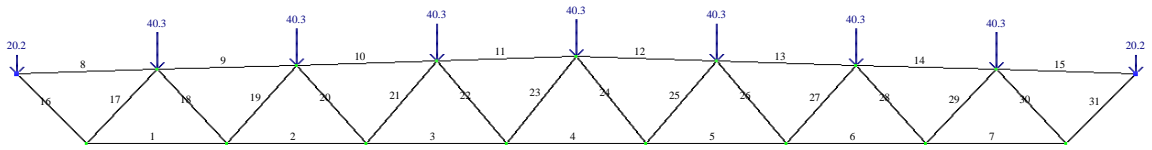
Схемы загрузений фермы временной кратковременной нагрузкой.
